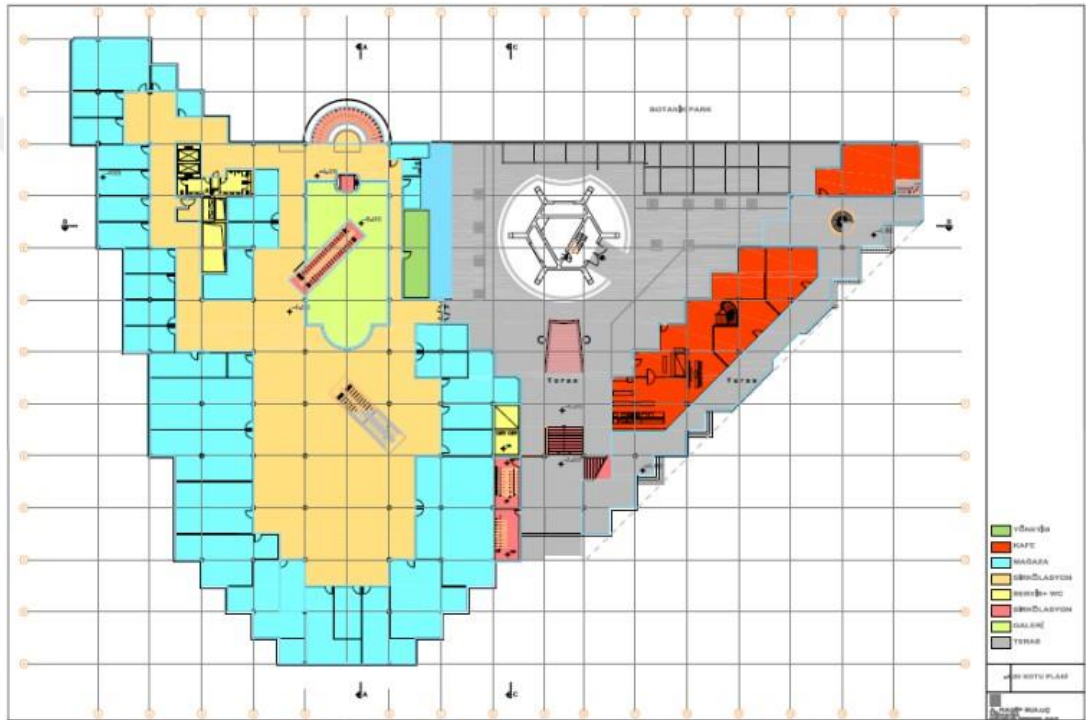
Birinci Kat (+4.00 Kotu) Planı
